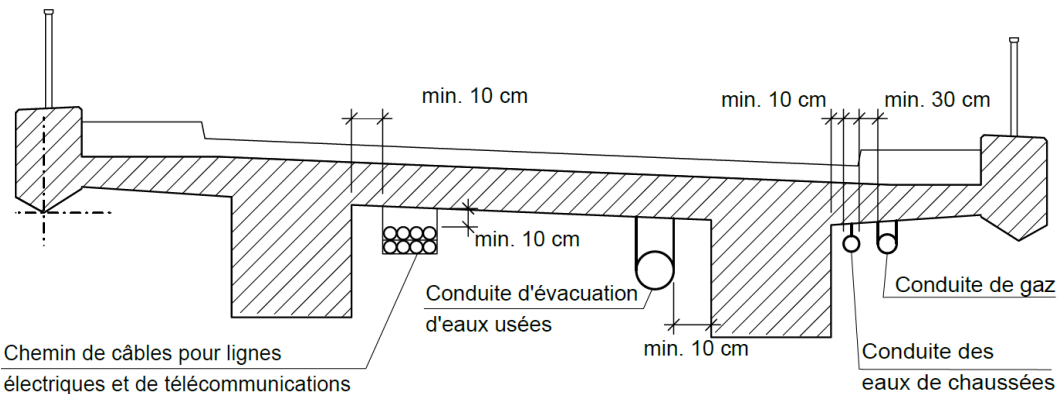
Coupe transversale d'un pont dalle avec diverses conduites techniques
